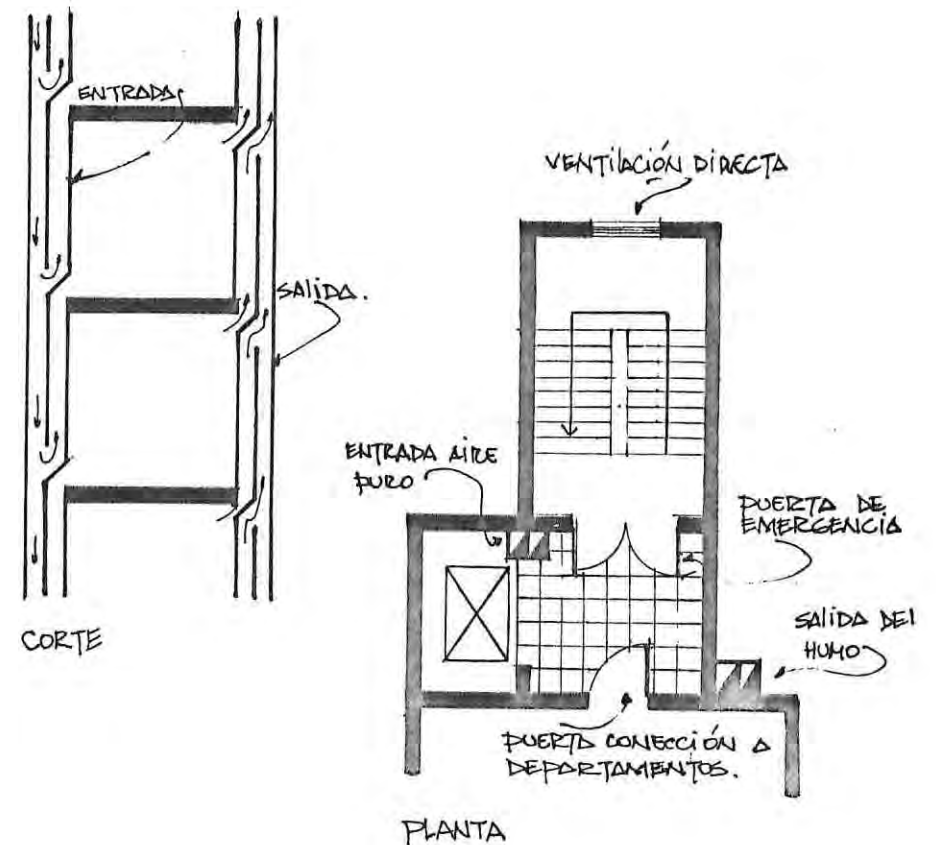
Corte y planta, del ducto de ventilación y área de seguridad.
